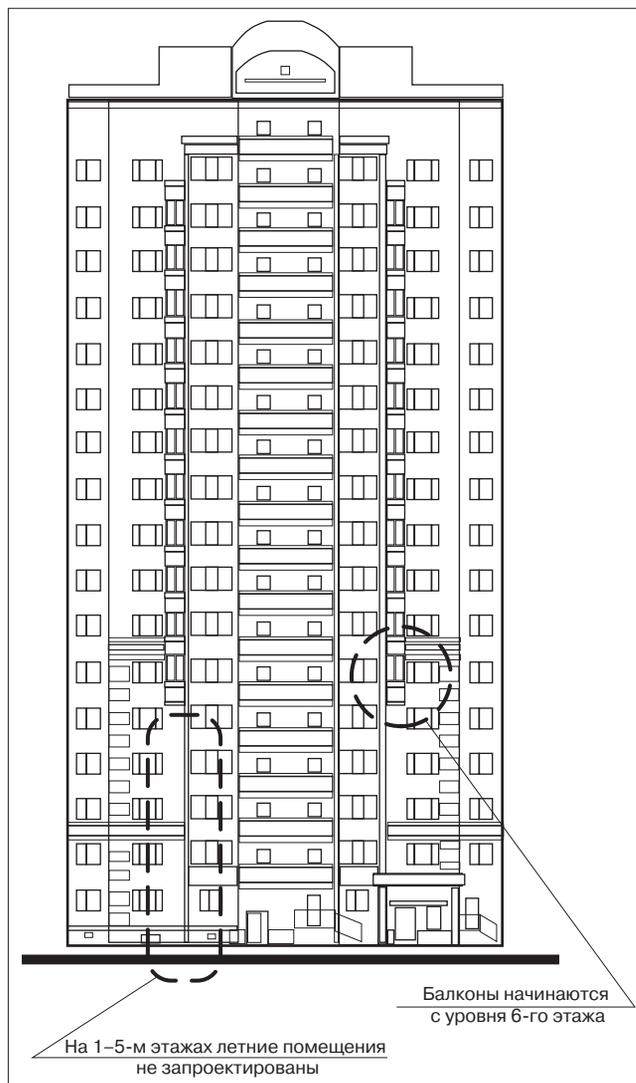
Схема фасада 17-этажной жилой блок-секции (действующий типовый проект)
